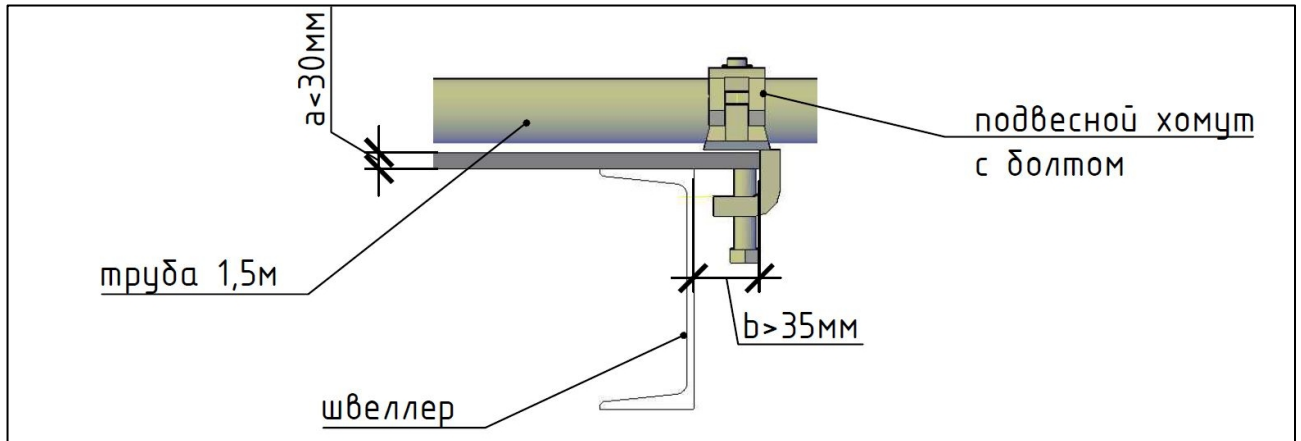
Узел 1. Крепление трубы к перекрытию (планка условно не показана)
